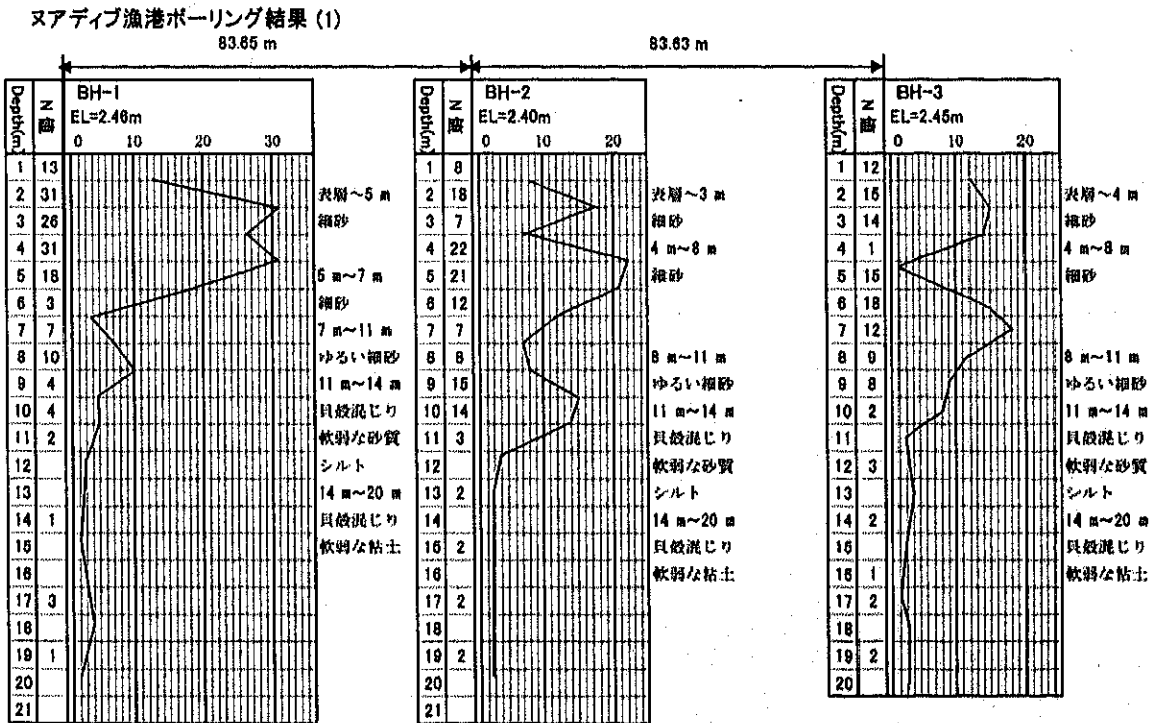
(4-1) 土質柱状図 (BH-1, BH-2, BH-3)
